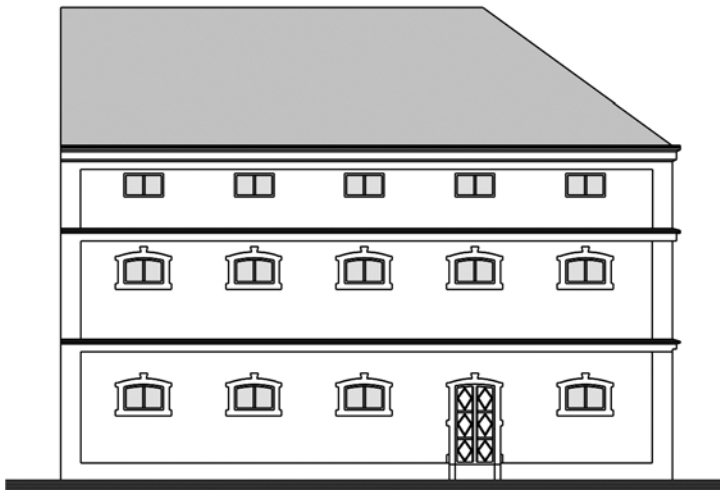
План маџаина Фердинанда Крена (Приватна збирка Крен)
